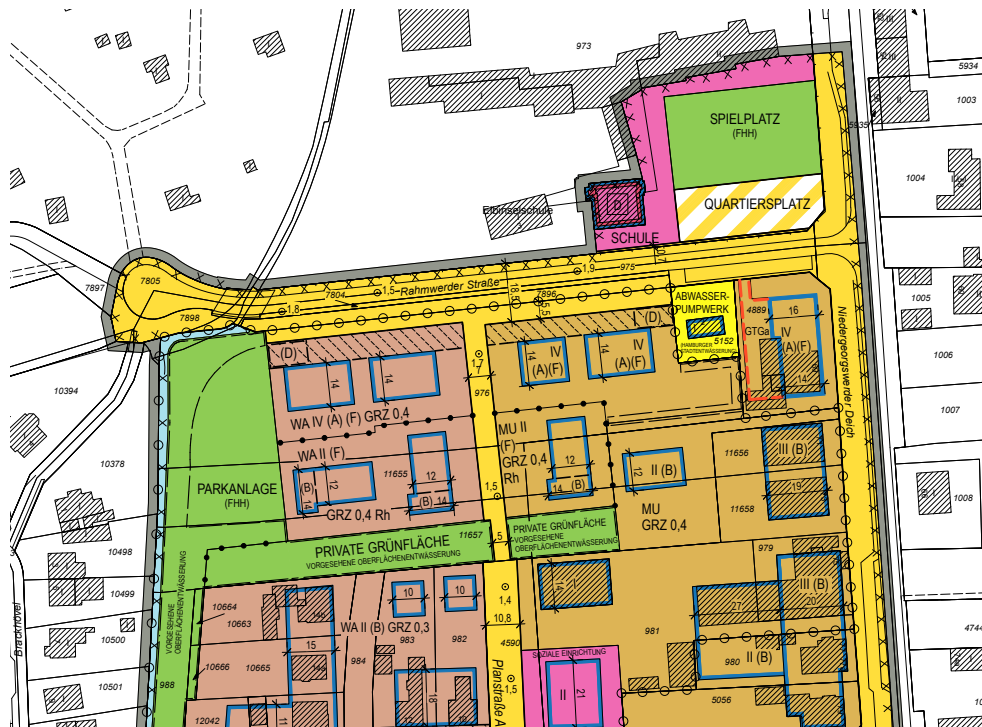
| Planungsrecht: Bebauungsplan Wilhelmsburg 97
